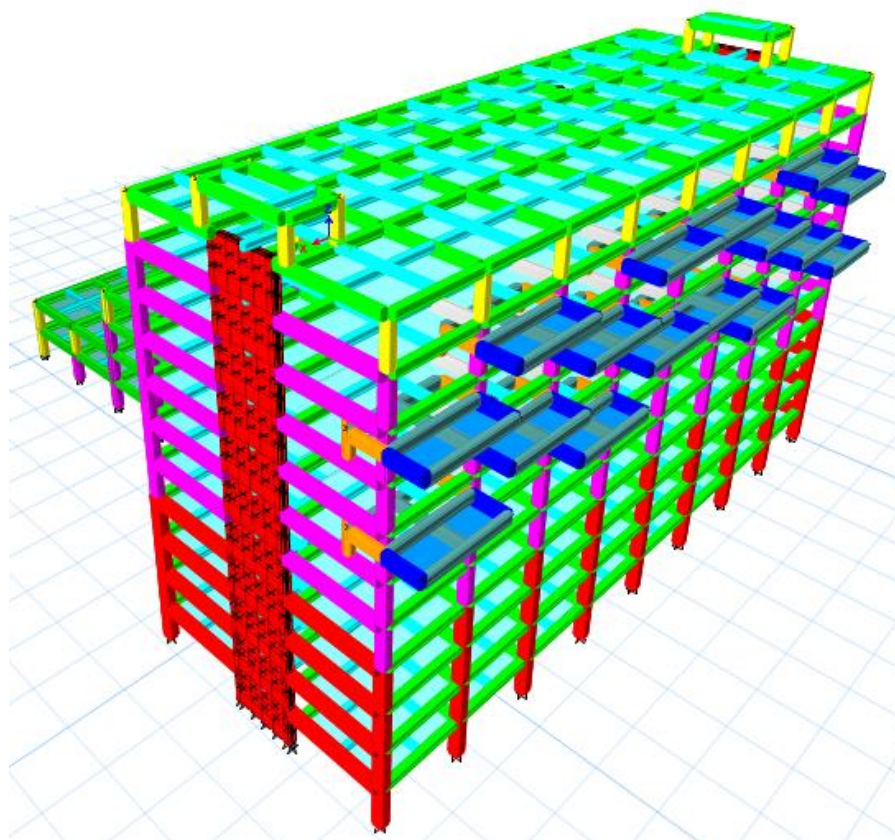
Tiga Dimensi Gedung Tampak Belakang Model 3
